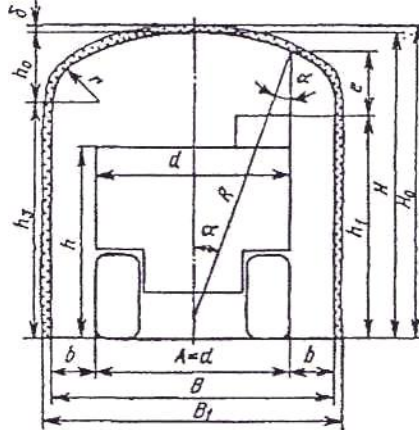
Сечение подэтажной выработки прямоугольно-сводчатой формы при безрельсовом транспорте с набрызг-бетонной крепью
